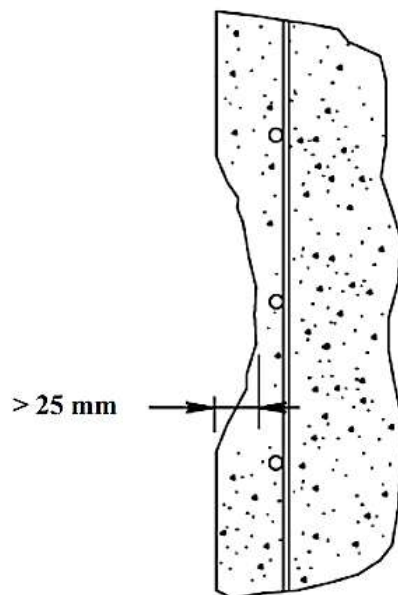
Detalle constructivo de descantillada de hormigón en revestimiento
